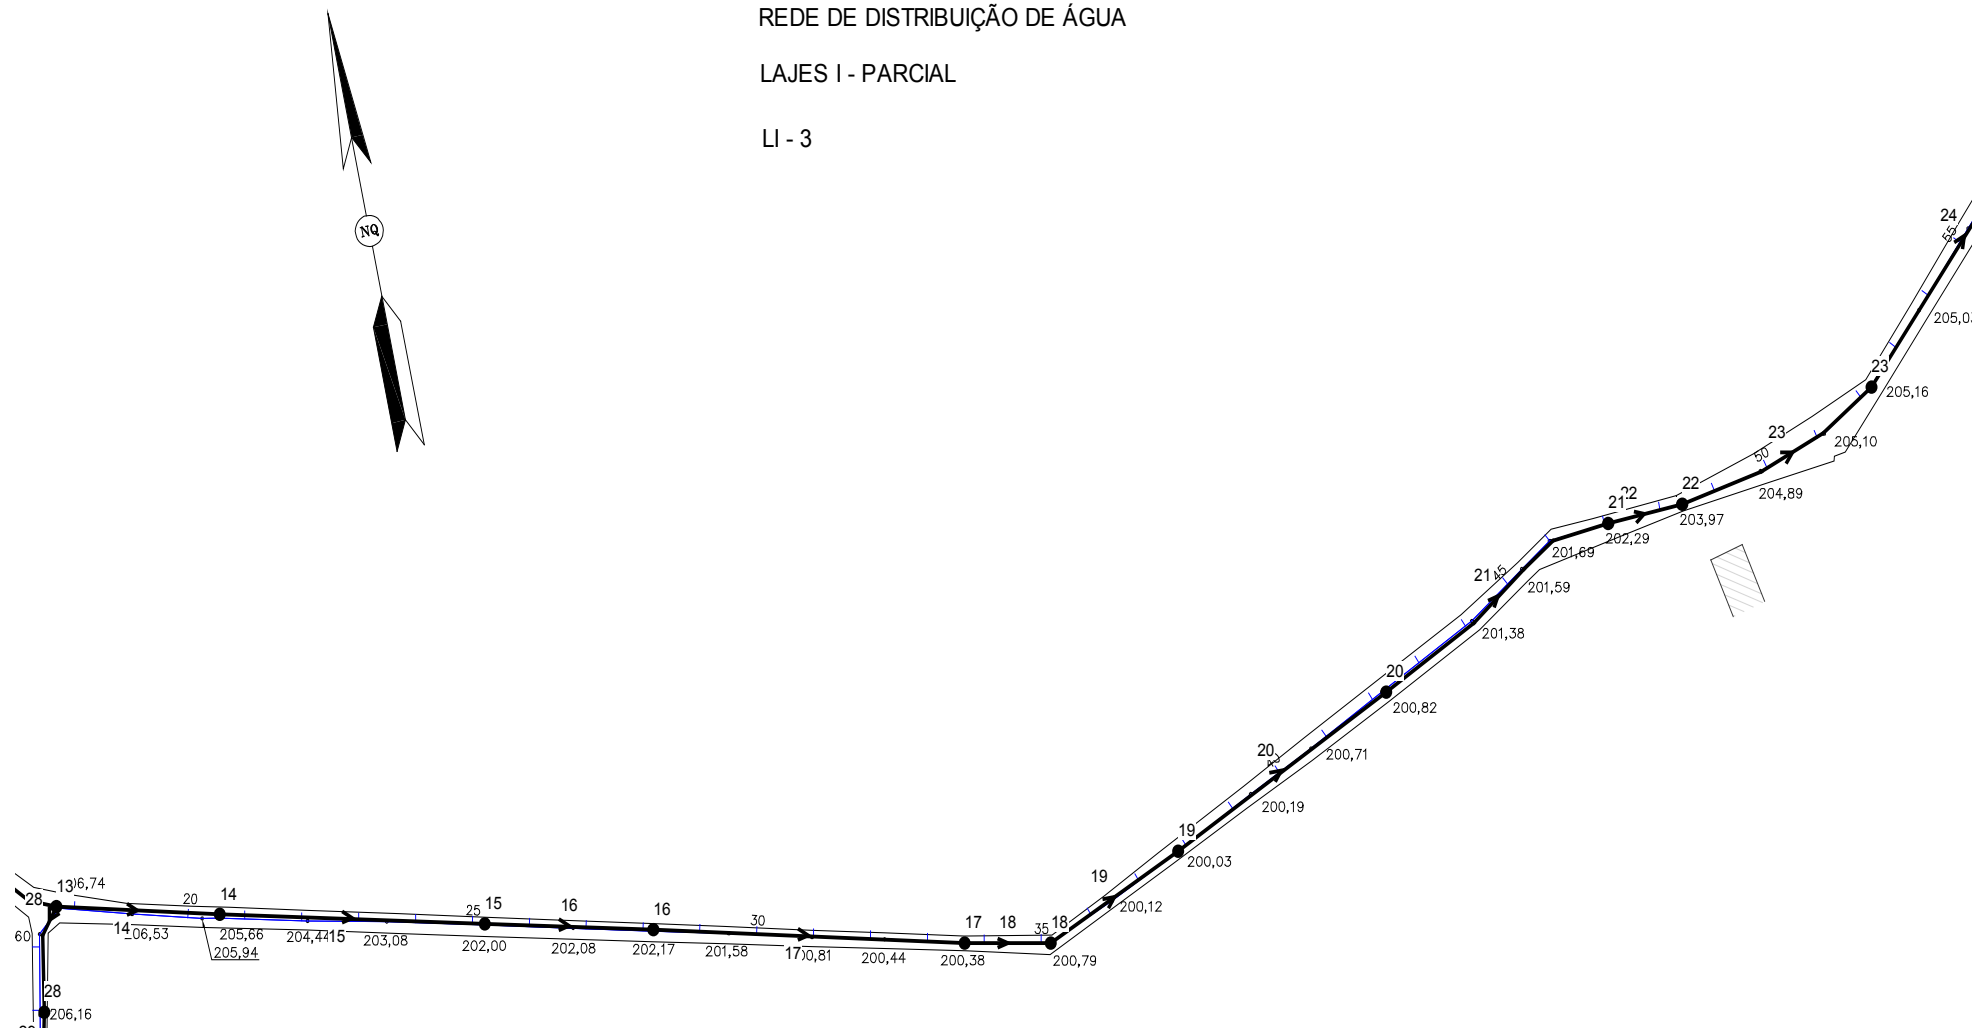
EPANET parcial 4 – Rede de Lajes 1
